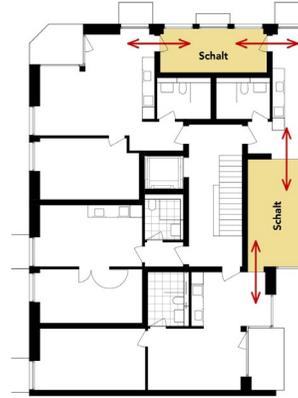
Grundriss mit Schalträumen | Klumpe Architekten (Mannheim)
